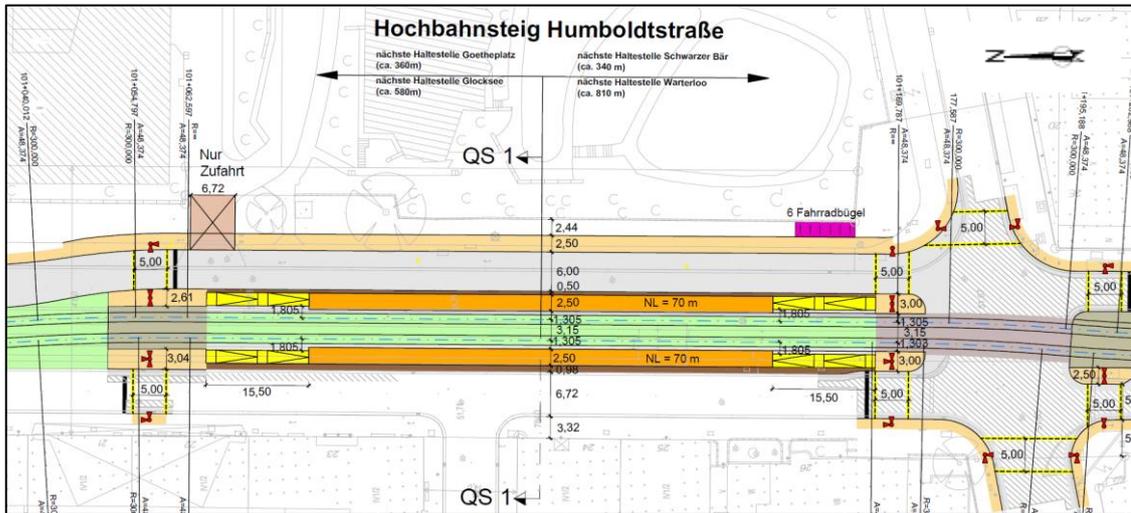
Lageplan Variante 1 Seitenhochbahnsteige Humboldtstraße (Ausschnitt)
